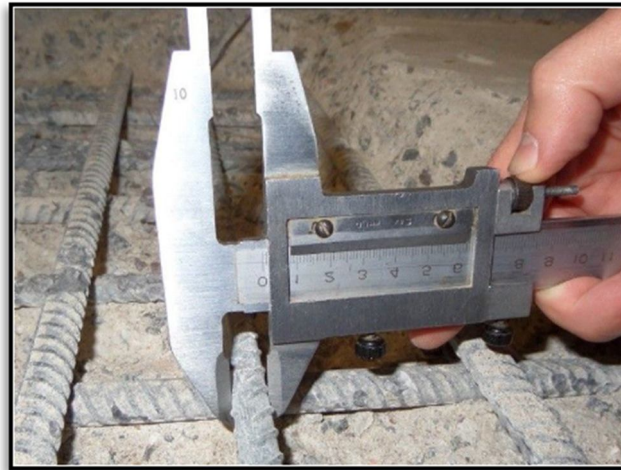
Розтин залізобетонної плити перекриття з метою встановлення діаметра арматури та товщини захисного шару бетону.
